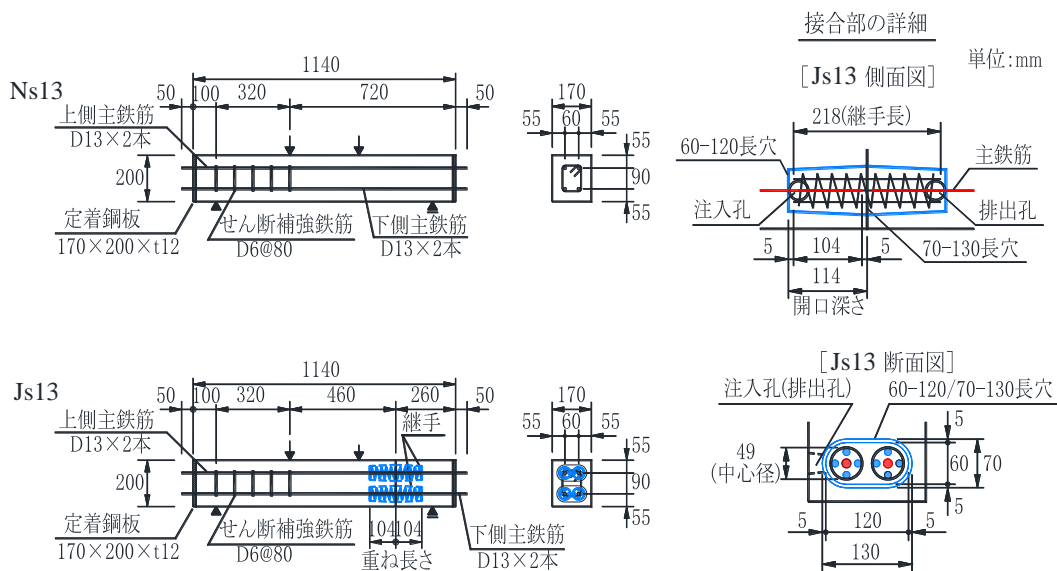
試験体の形状寸法と配筋 (D13 シリーズ)
